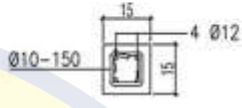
2 Detail Gambar Tulangan Profil C Baja Ringan
